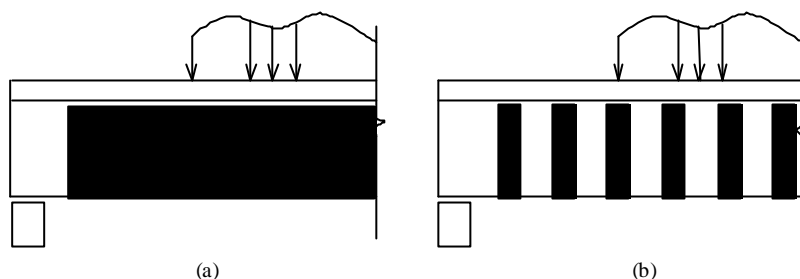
Disposición del refuerzo continuo o discontinuo.
